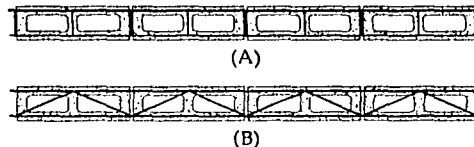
Refuerzo horizontal de la hilada o juntas (vista en planta)
